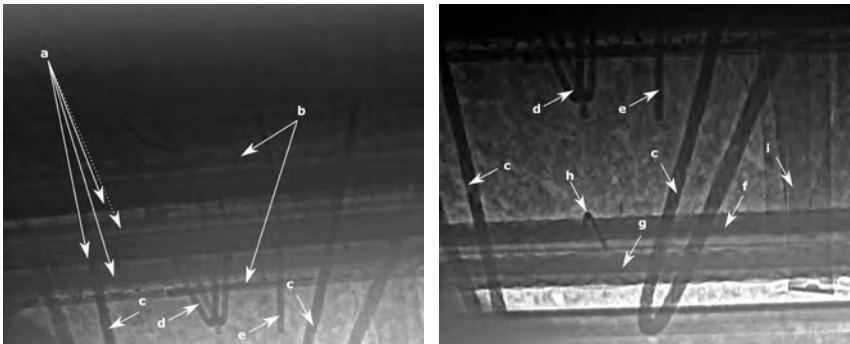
Detailansichten Röntgenbilder inklusive Markierung identifizierbarer Bauteile [Quelle: bauray GmbH]
